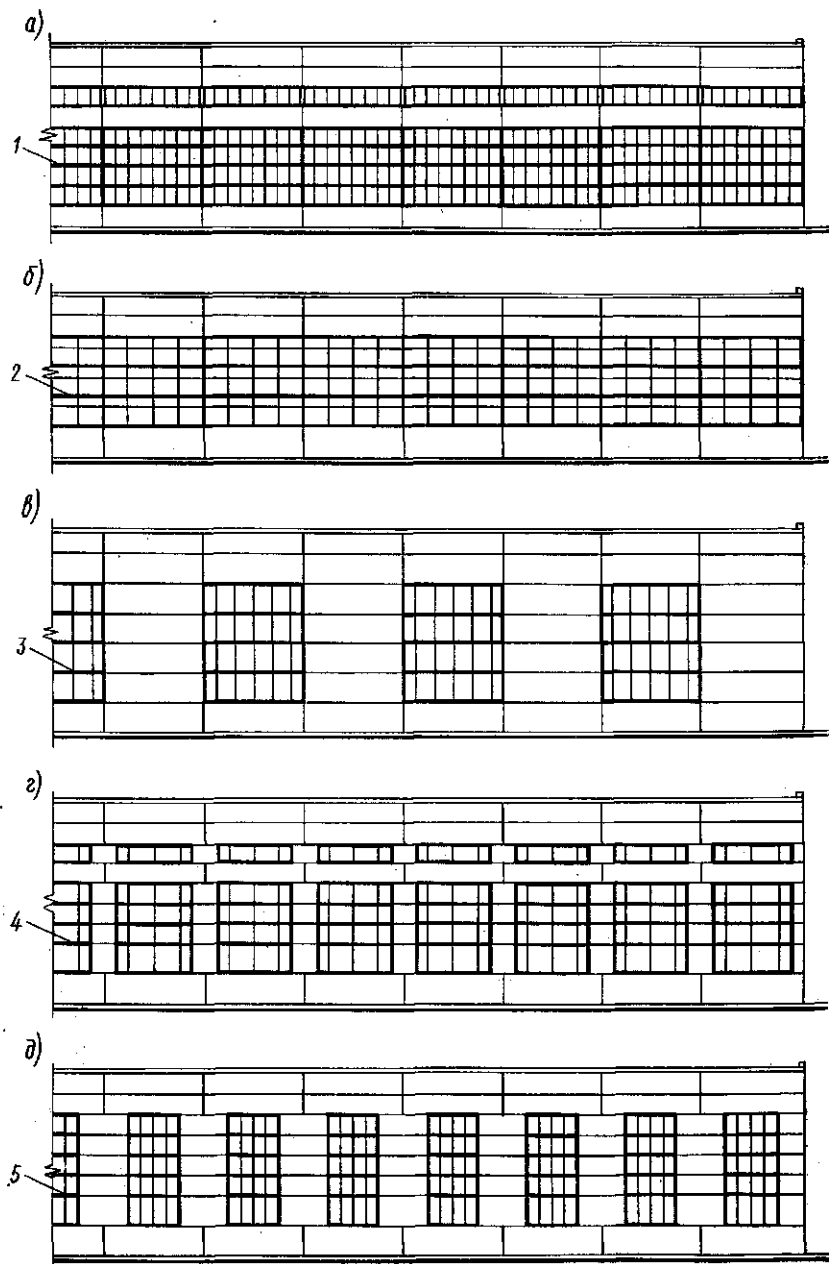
Варианты разрезки стен одноэтажных зданий:
